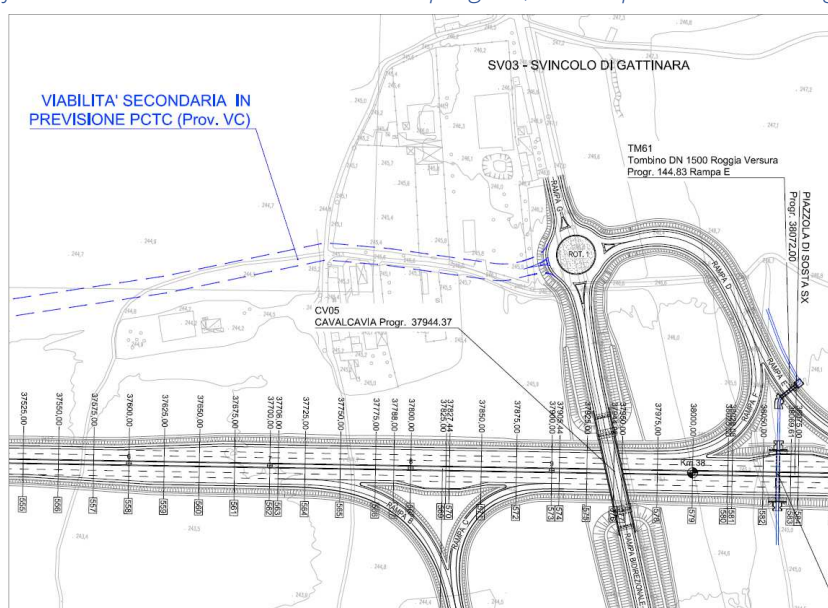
Stralcio planimetrico Svincolo di Gattinara
